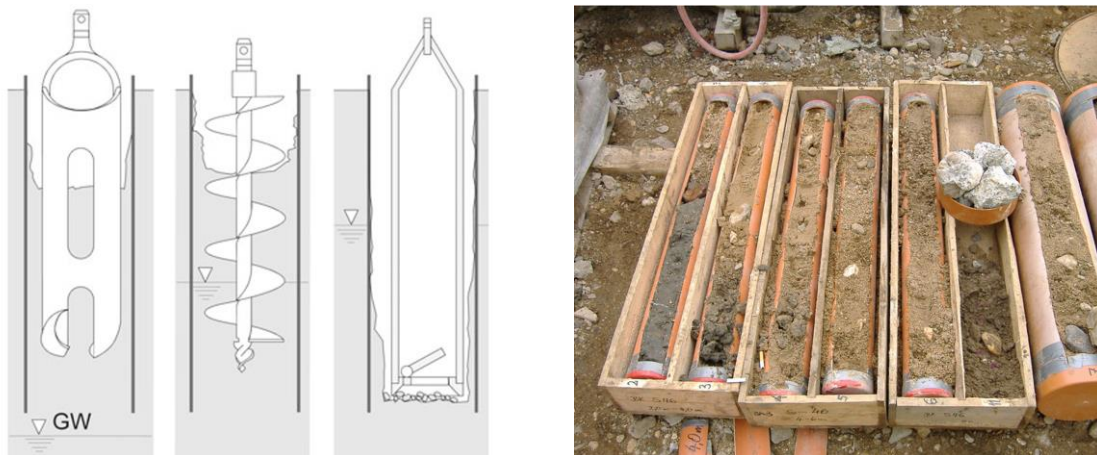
Links – Werkzeuge zur Bohrgutentnahme bei einer Trockenbohrung (Boley, 2012);
